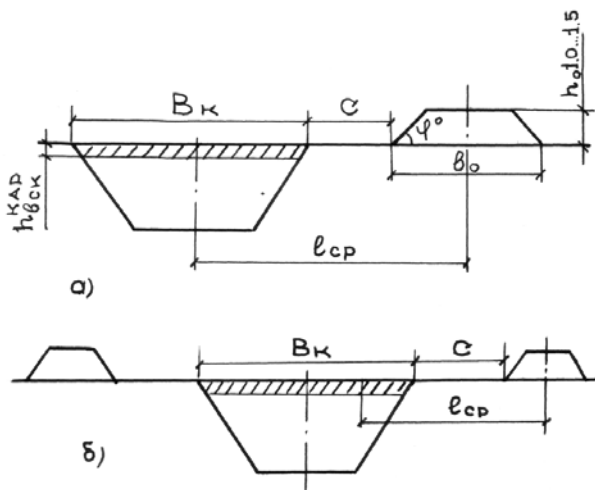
Схема к определению среднего расстояния перемещения грунта при вскрыши карьера с укладкой грунта: а – на одну сторону; б – на обе стороны
